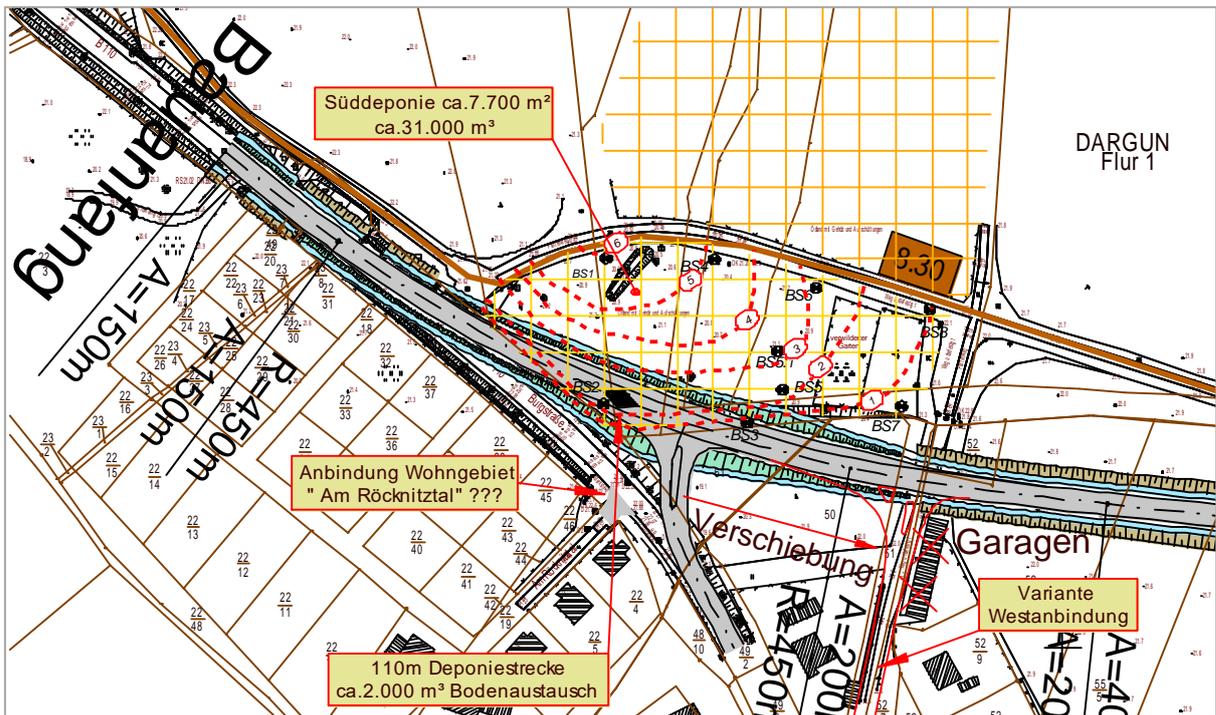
Trassierungsuntersuchung 1. Stufe „Trasse mit Minimalabstand zur Bebauung“ (Variante 5.1)
